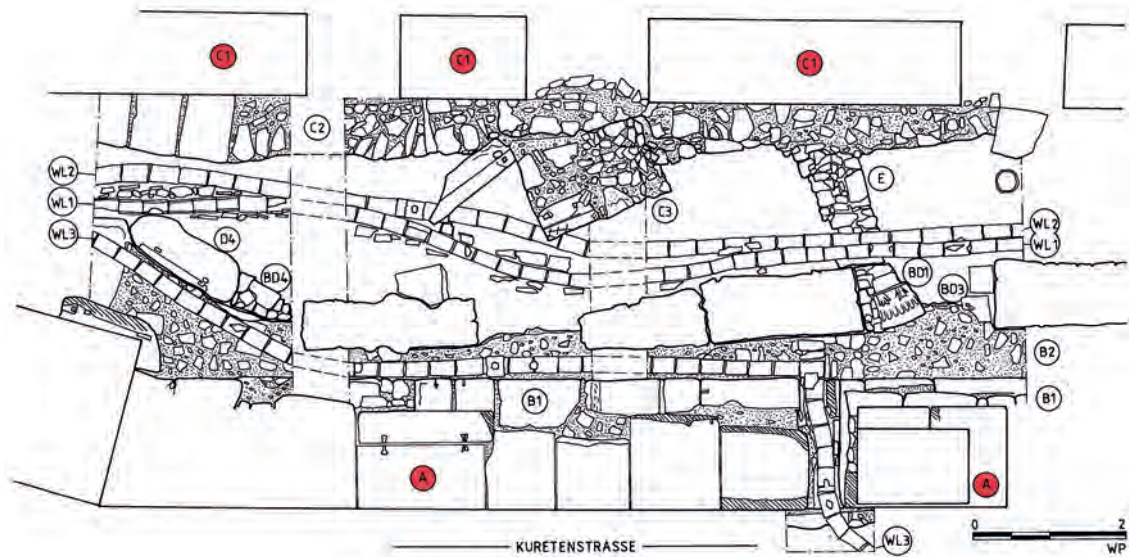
Steingerechter Plan der Kuretenhalle mit markiertem Stylobat A und Hallenrückwand C1
